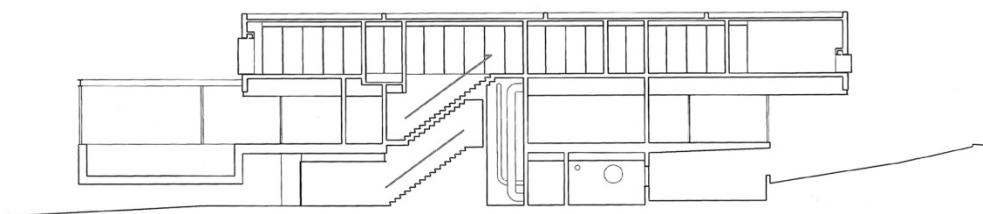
Sección CC. 2G Revista Internacional de Arquitectura
